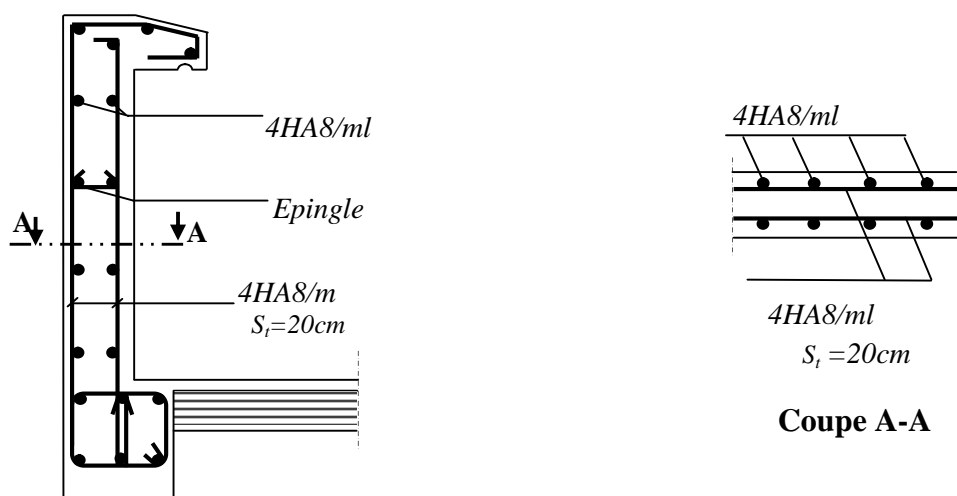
Schéma de Ferrailage de l'acrotère
